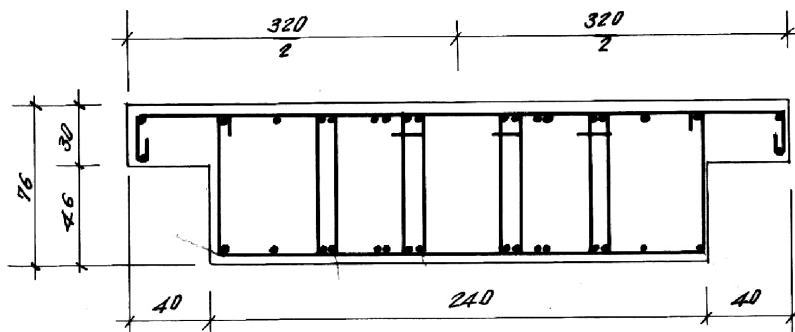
Prerje tërthore e elementëve lidhës të kolonave
